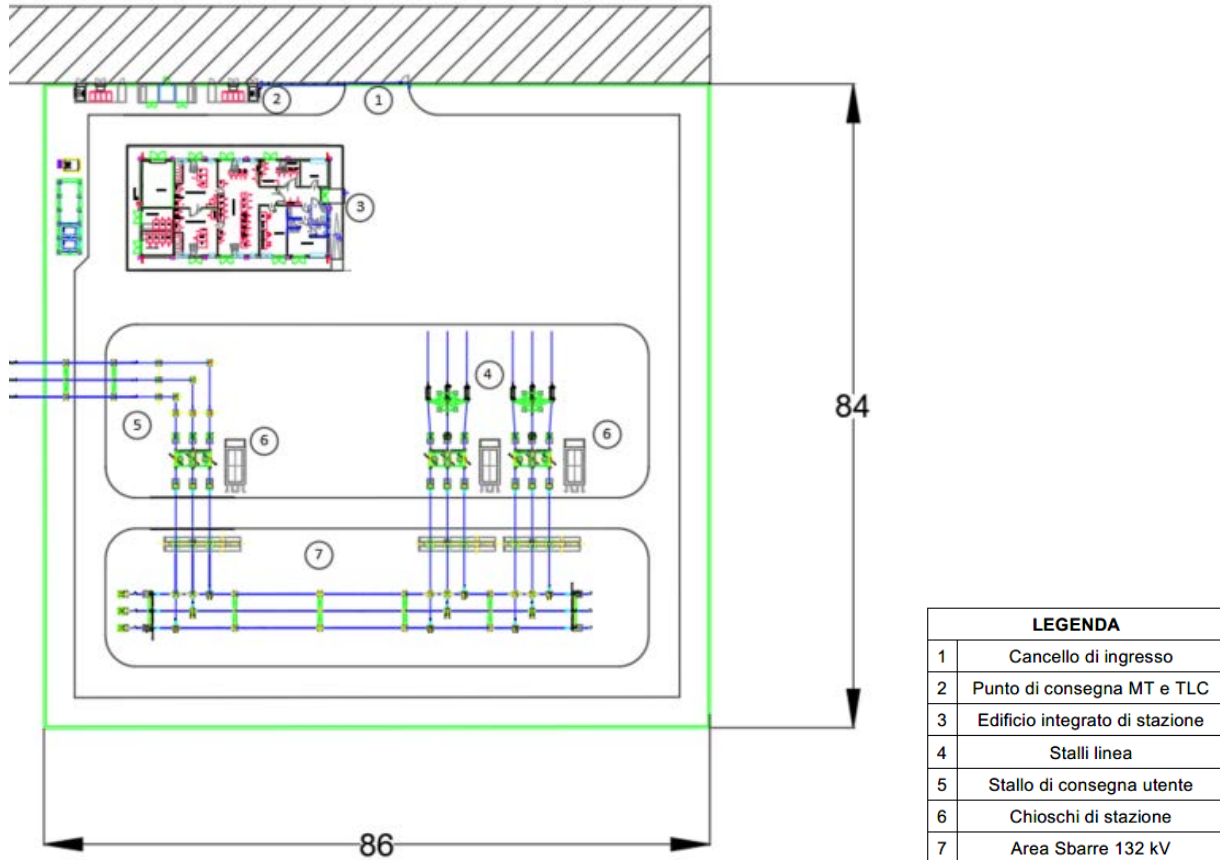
Planimetria futura Stazione Elettrica RTN
